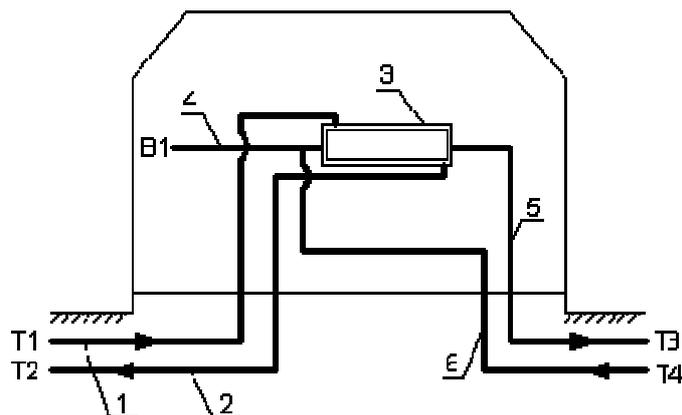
Схема ЦТП при закрытой схеме горячего водоснабжения: 1, 2 – подающий и обратный трубопроводы теплоносителя (пар или горячая вода не питьевого качества); 3 – скоростной водонагреватель; 4 – трубопровод подачи холодной воды из наружной водопроводной сети или от гидропневматического бака при наличии насосной станции подкачки; 5, 6 – подающий и циркуляционные трубопроводы системы горячего водоснабжения
